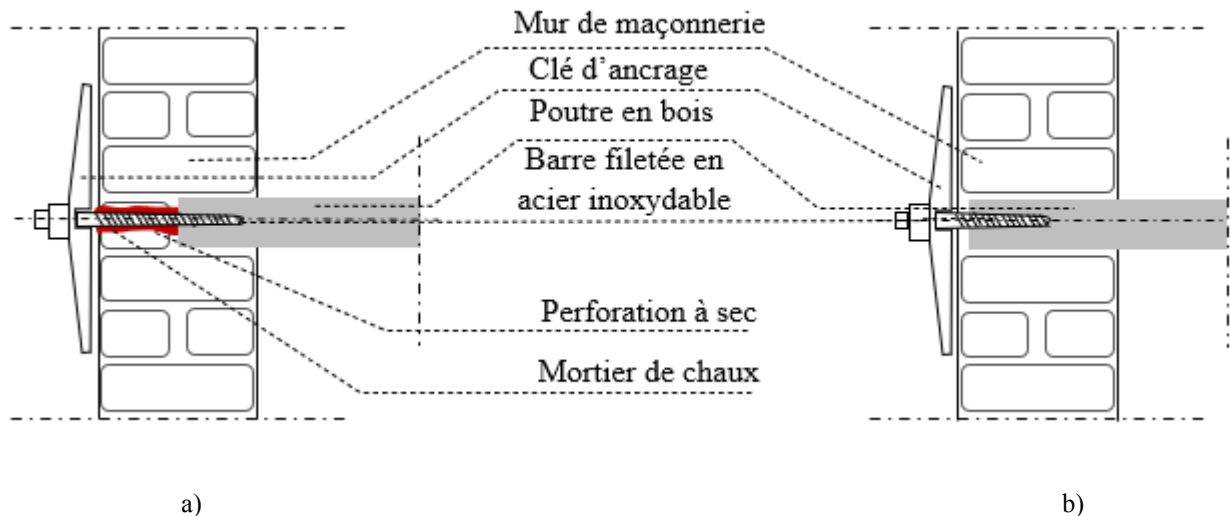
Schéma du système d'ancrage (Source : auteur)
